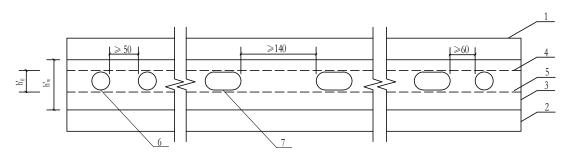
钢肋腹板上管线穿孔布置示意图
